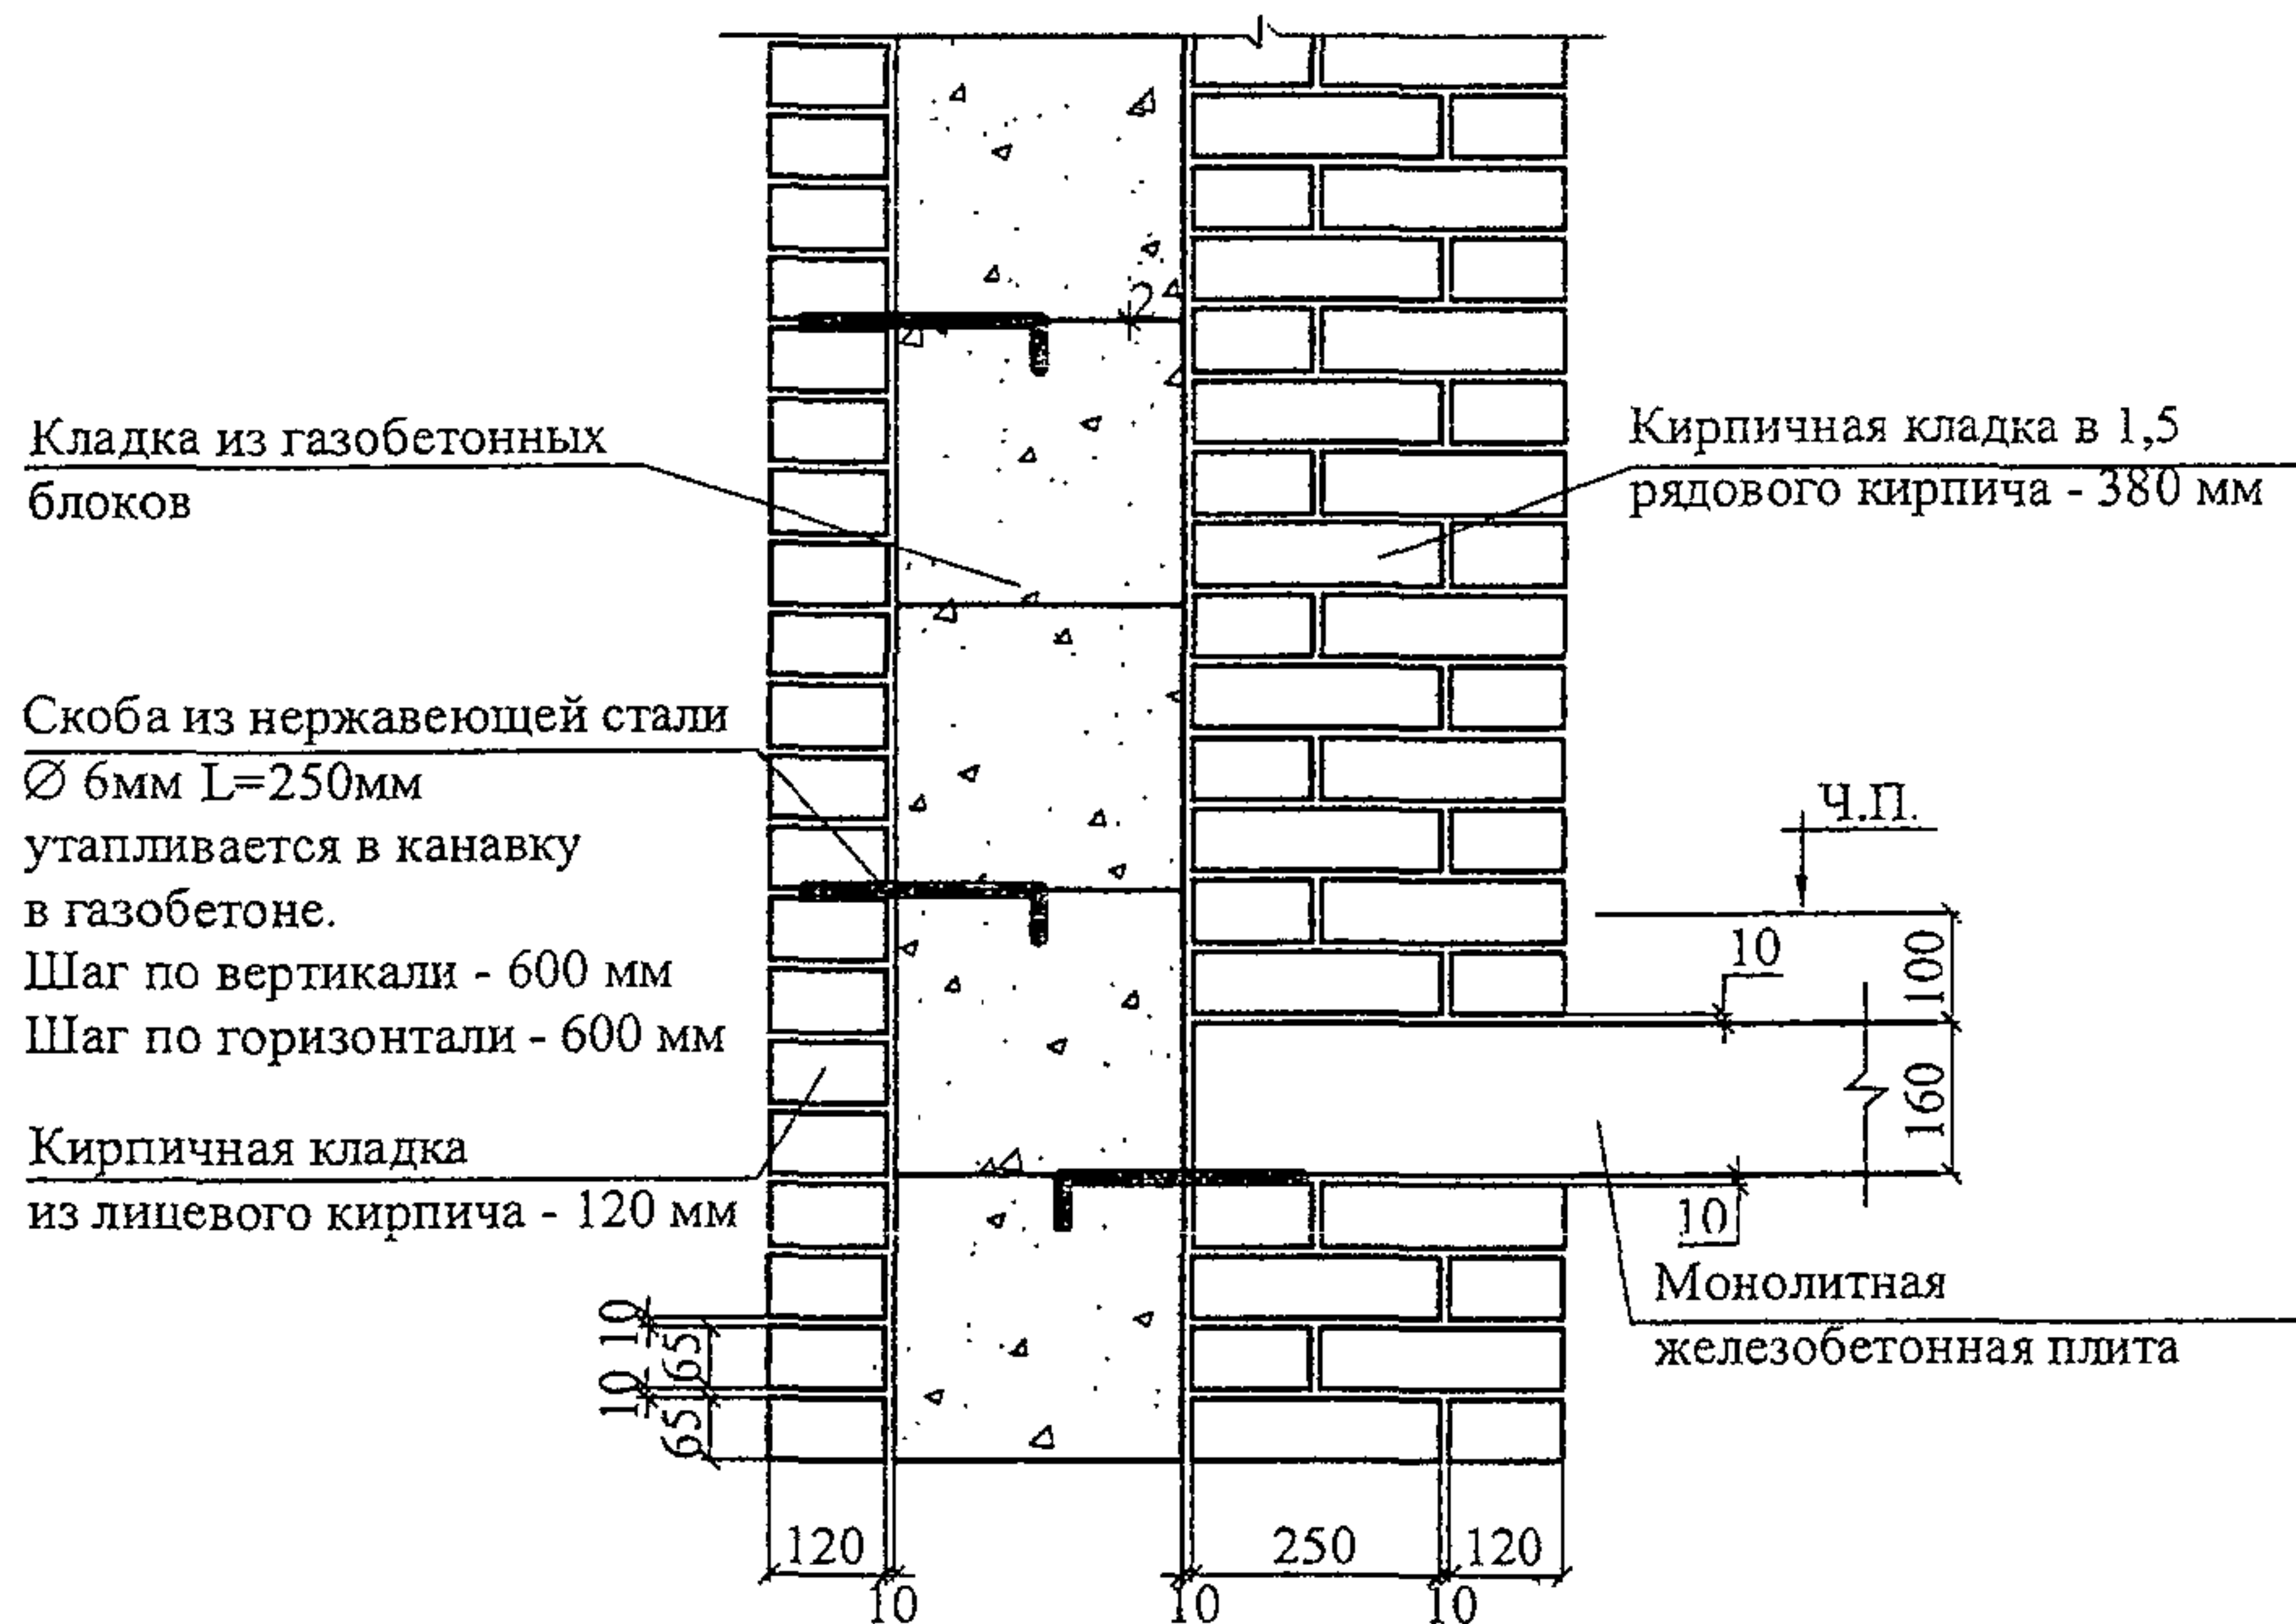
Несущая кирпичная стена малоэтажных домов с наружными газобетонными самонесущими блоками на клею и кирпичной облицовкой
